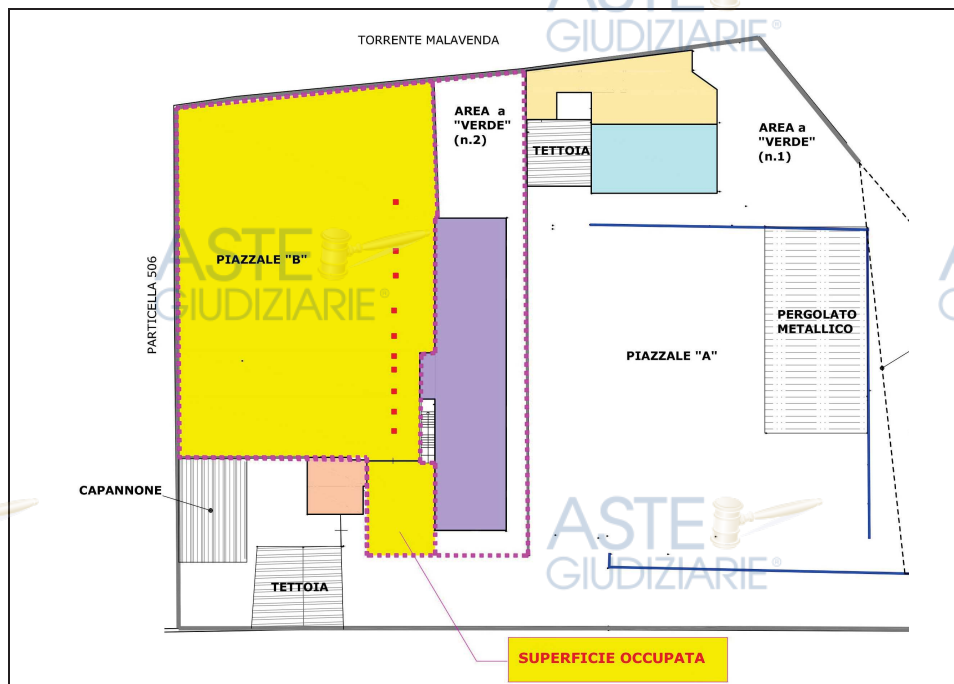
Stralcio planimetrico –area oggetto di occupazione
